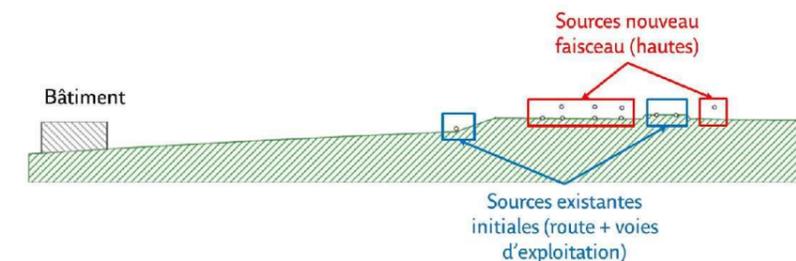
Coupe au droit du bâtiment n°5 par rapport au faisceau de voies.
